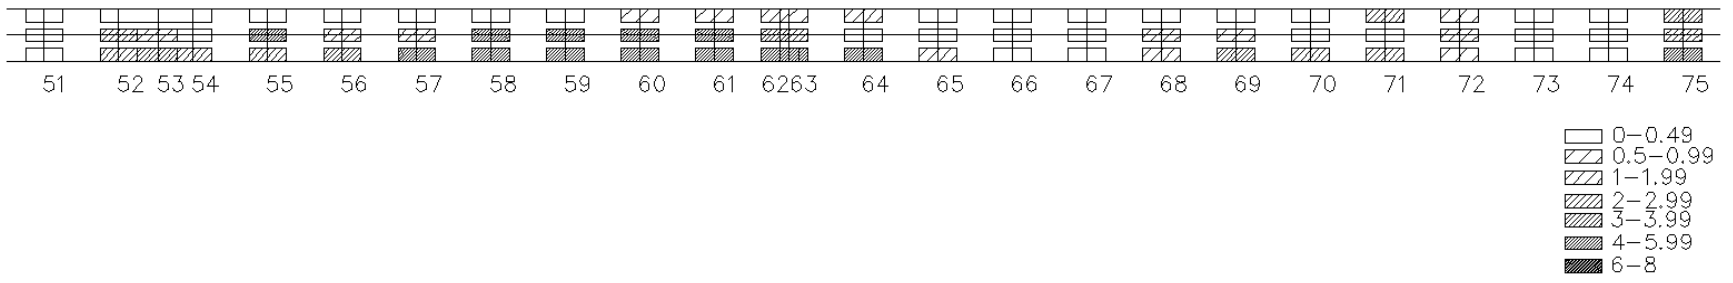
Frästiefen bei kubischer Splinefunktion und Verfahrensplan Typ C, Grundriss, Stationen 51-75
